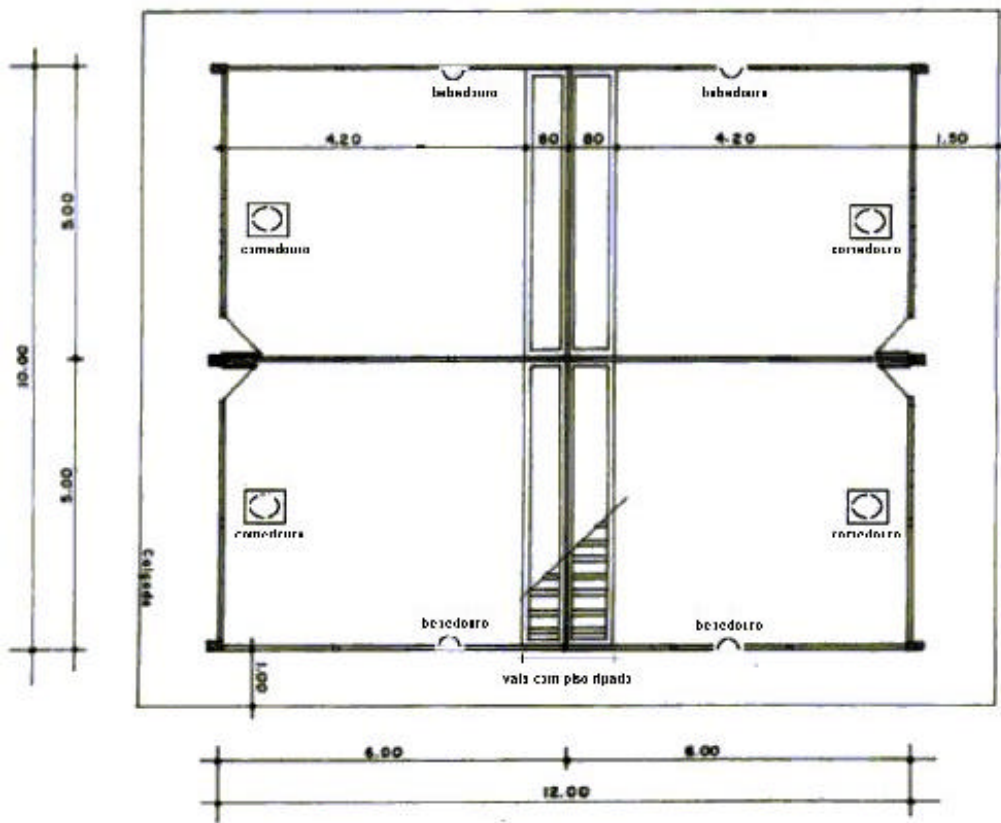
Planta baixa da instalação com sistema piso concretado.
